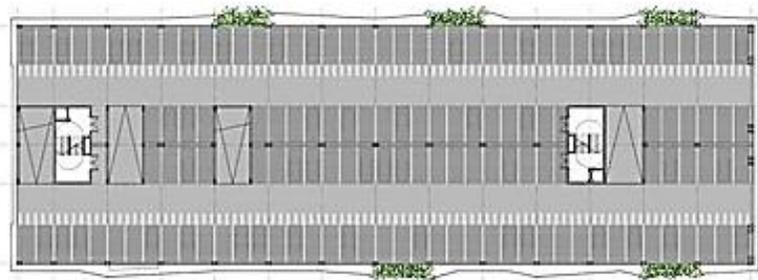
Planta Estacionamiento Soissons / Jacques Ferrier Architectures
